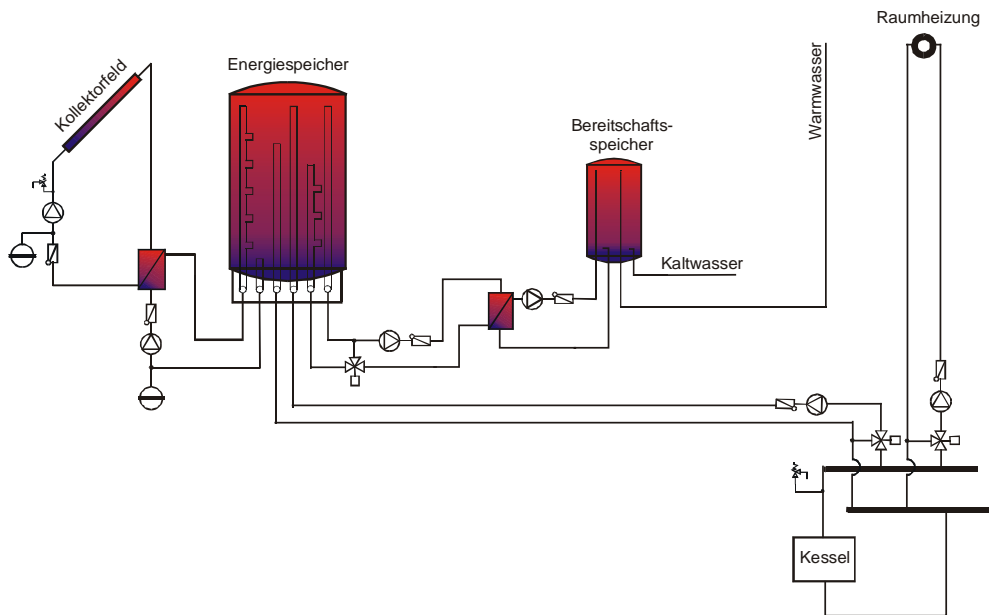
Hydraulikschema der Solaranlage zur Warmwasserbereitung und Raumheizung für ein Einfamilienhaus
